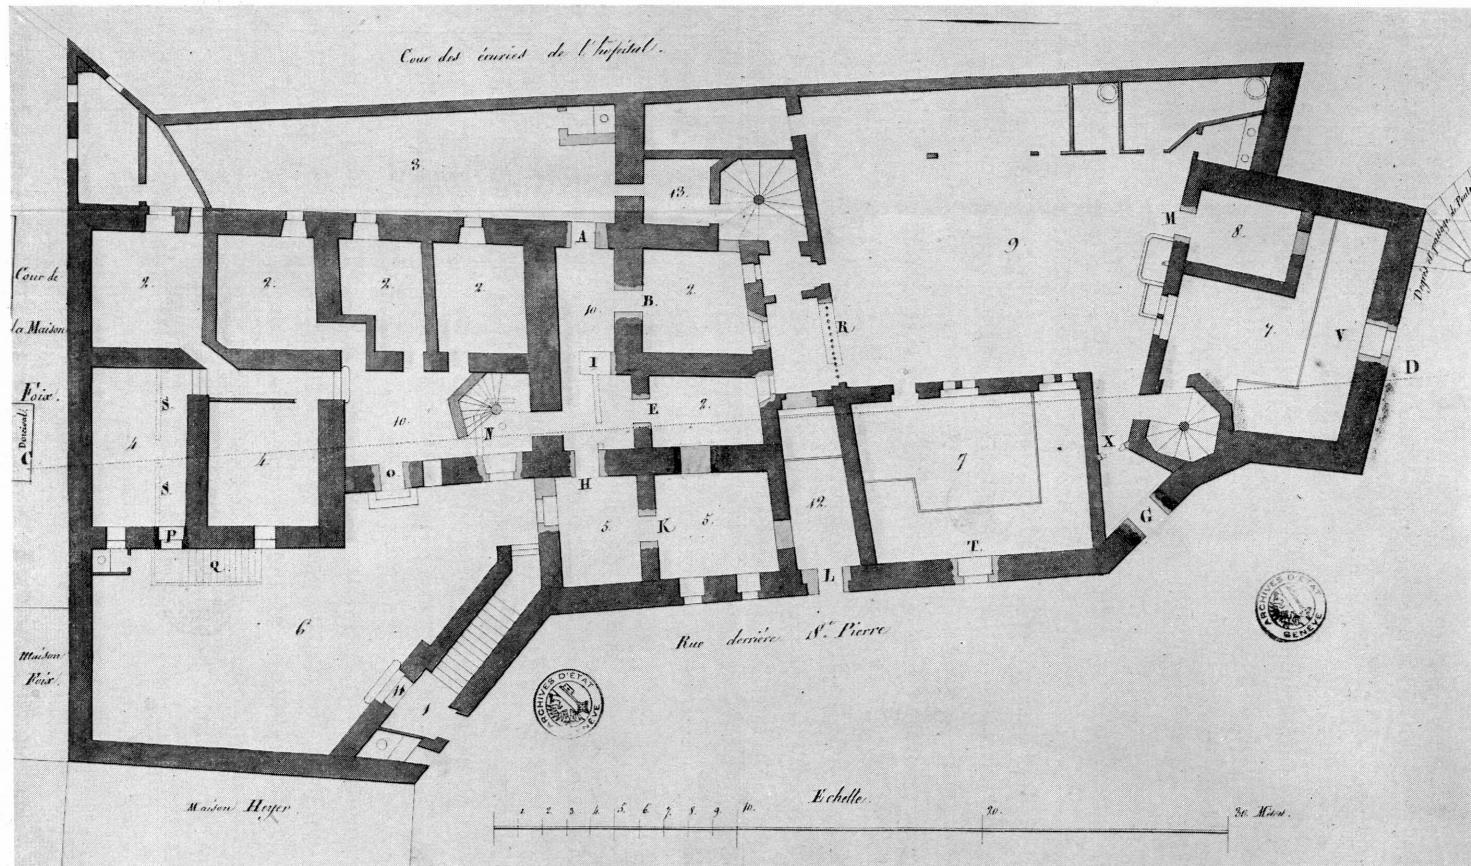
Plan Blanvillain de 1813. Rez-de-chaussée de l'Evêché.
